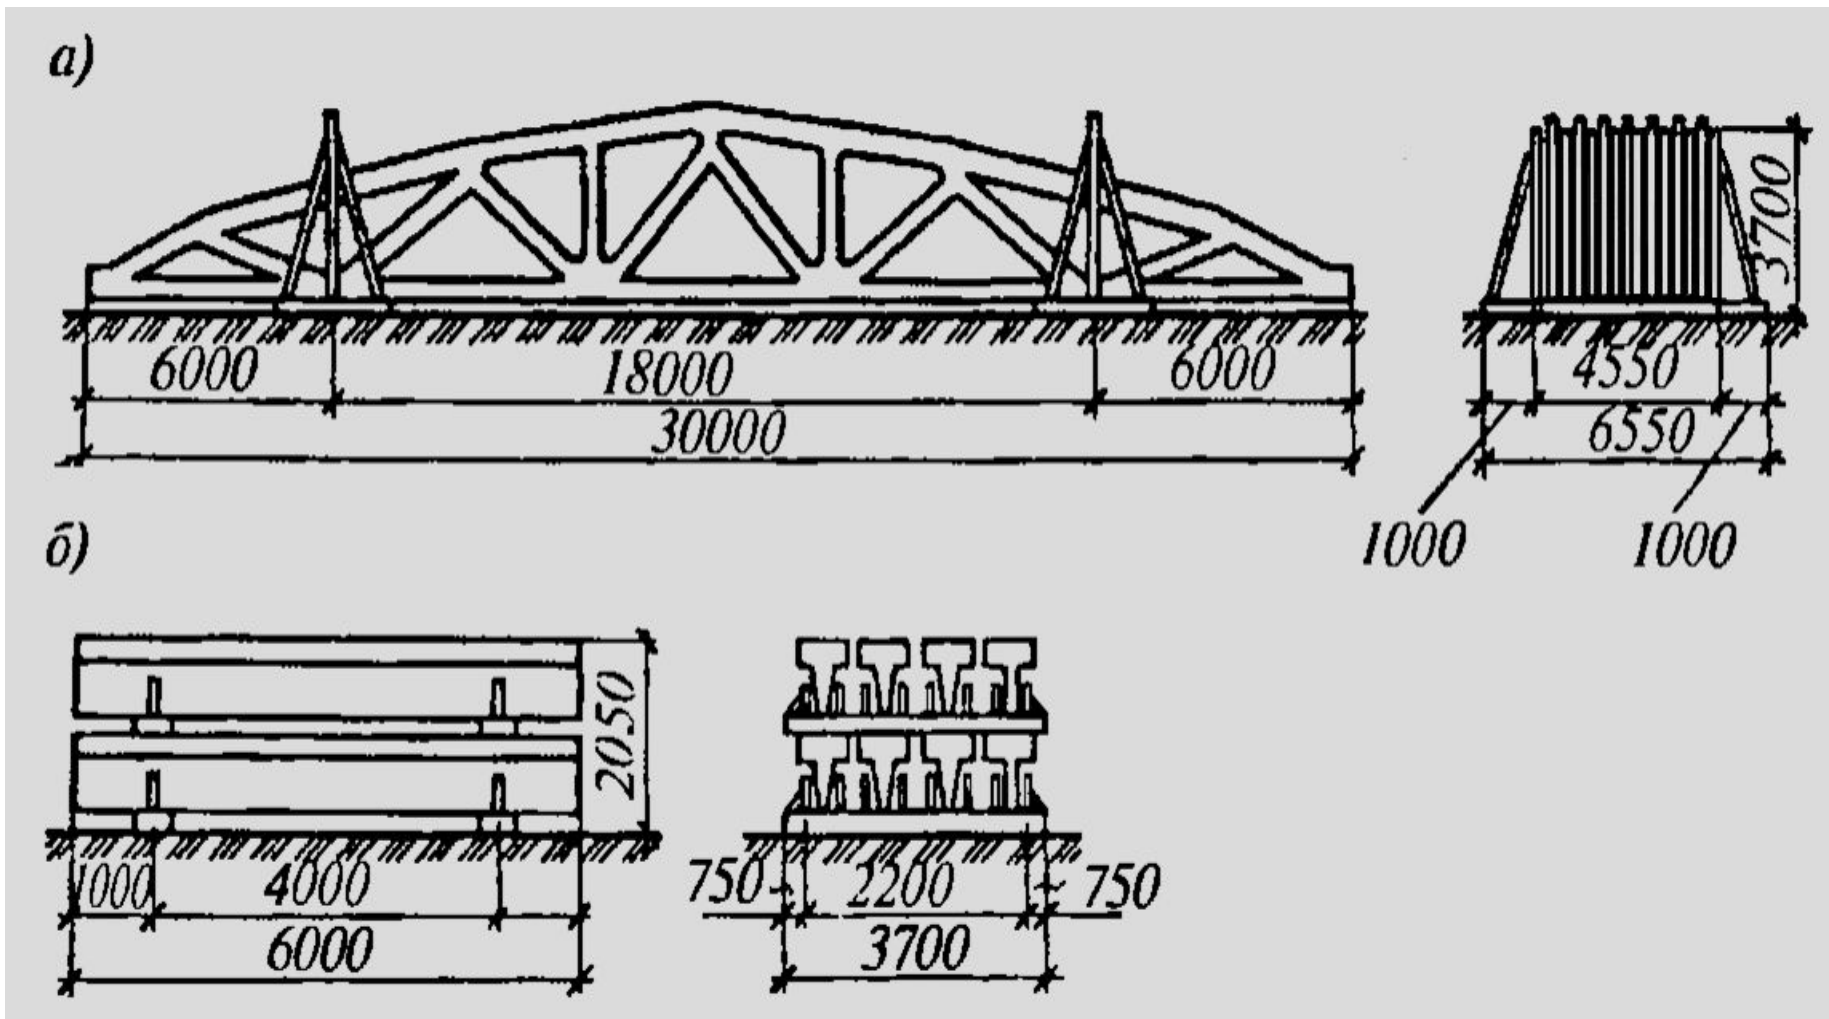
Складирование ферм и балок на приобъектном складе:
